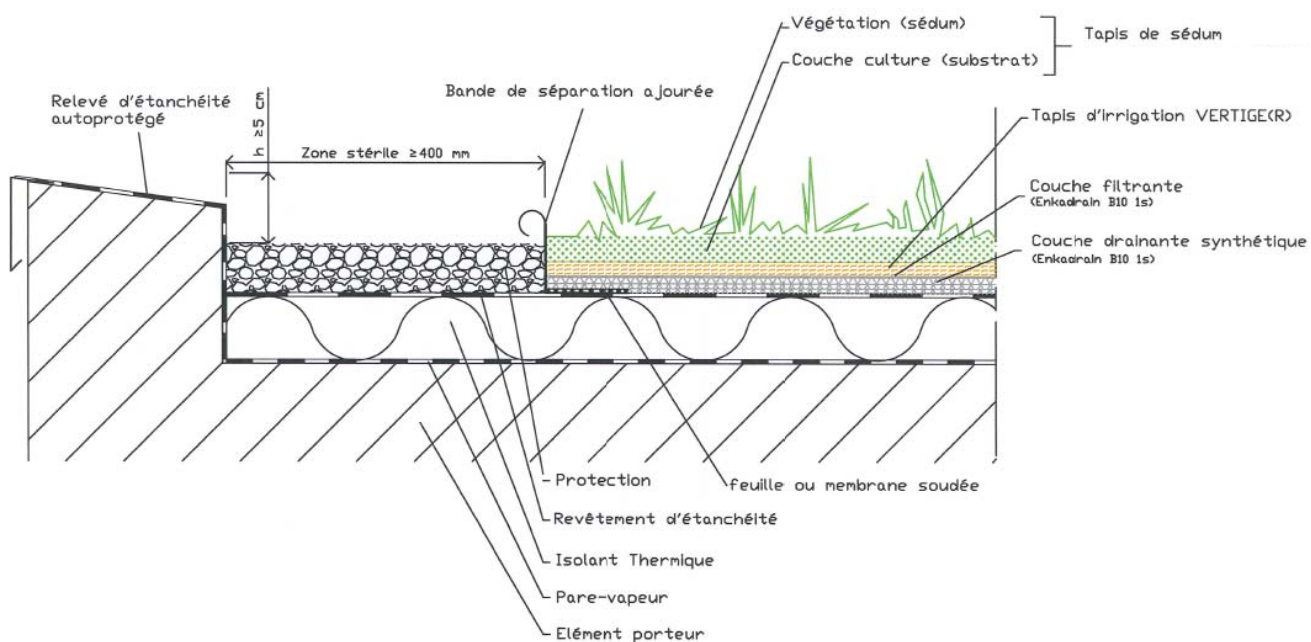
Coupe type sur relevé avec zone stérile, élément porteur en maçonnerie, de pente comprise entre 2 % et 20 %
